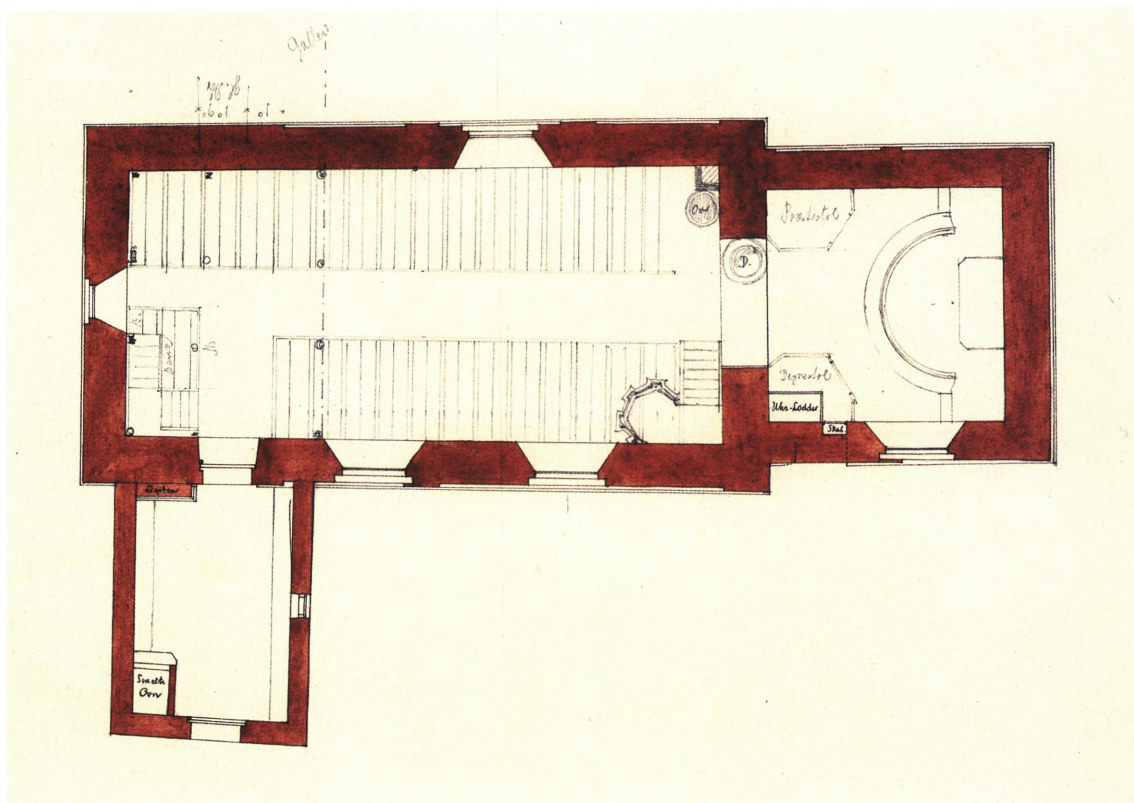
Opmåling 1:150. Plan. Forarbejde til Danske Tufstenskirker. Målt og tegnet af E. Schiødt 1884. – Grundriß. 1884.
